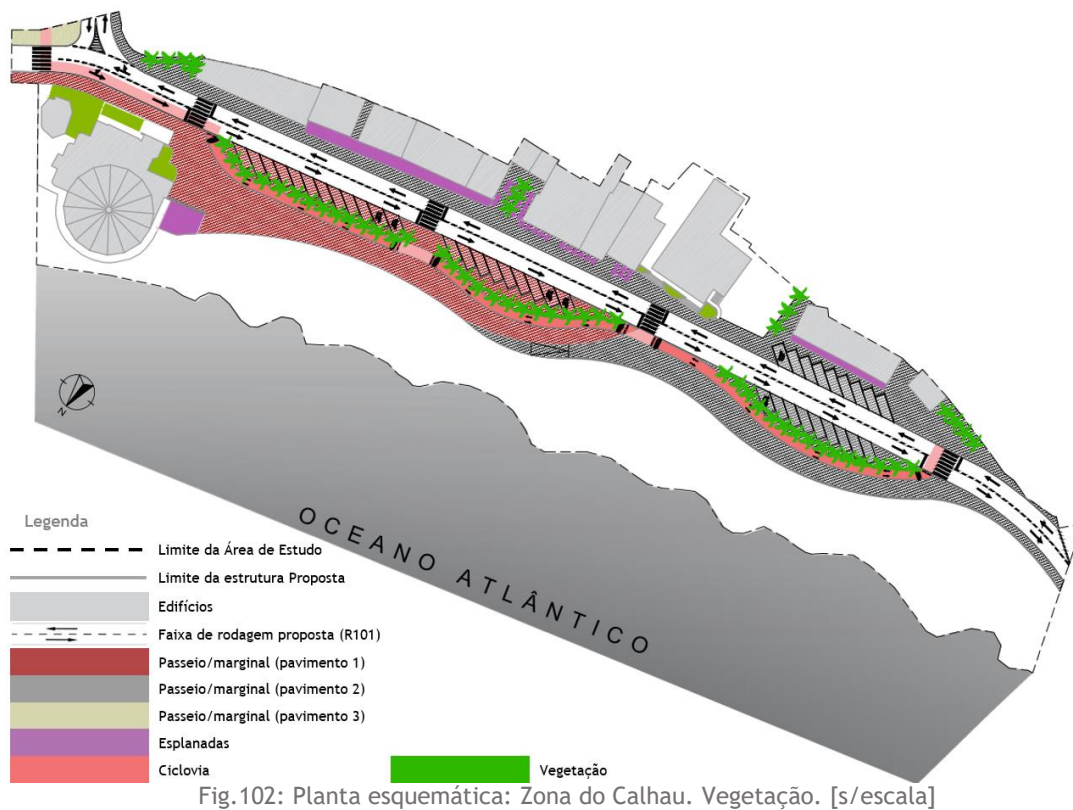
Planta esquemática: Zona do Calhau. Vegetação. [s/escala]
